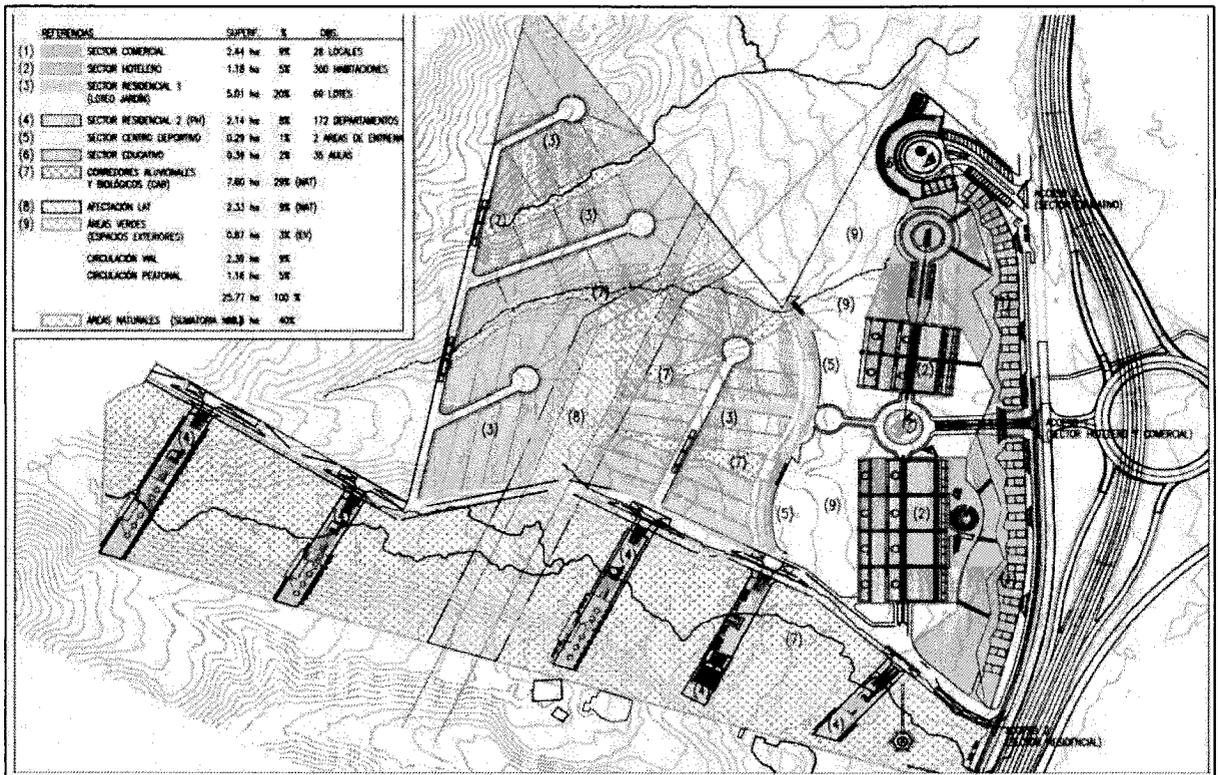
Planimetría Master Plan Cañadones de Piedemonte. Fuente: MGIA
